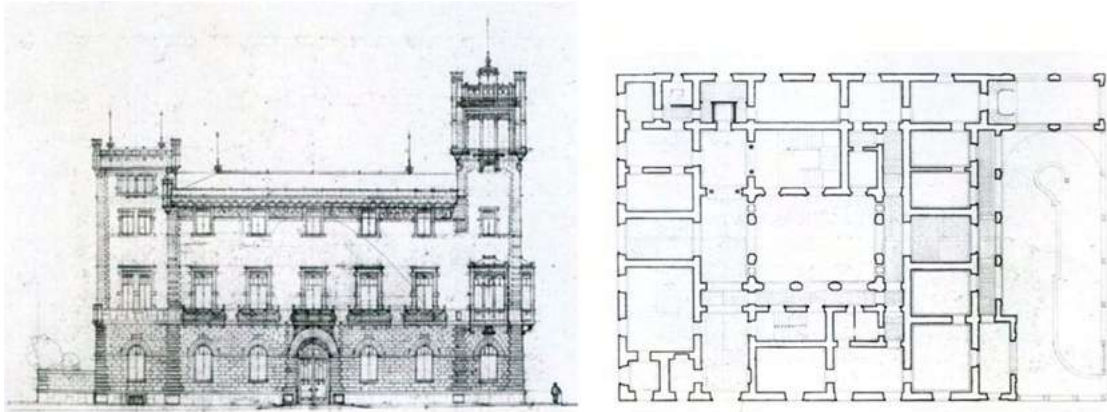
Villa dei principi di Manganelli, alzato del fronte principale, pianta del piano terreno (Archivio dotazione Basile)..
